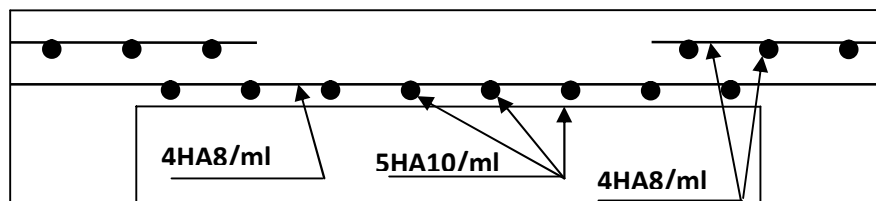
Schéma de ferrailage du premier type de balcon.
